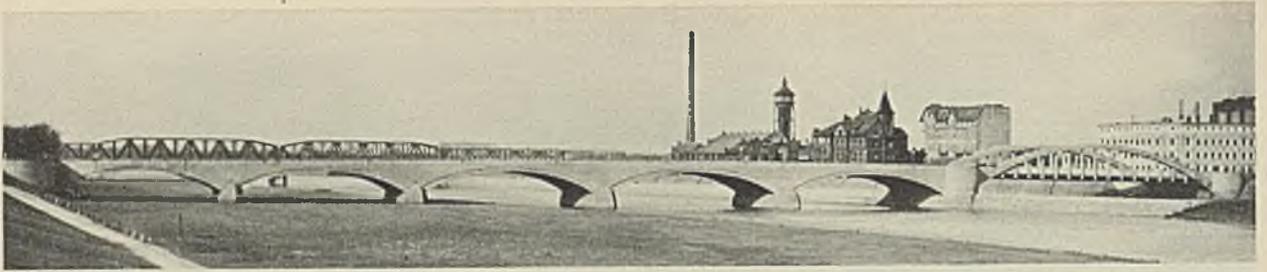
Straßenbrücke in Breslau über alte Oder und Breitenbachfahrt (Hindenburgbrücke).
